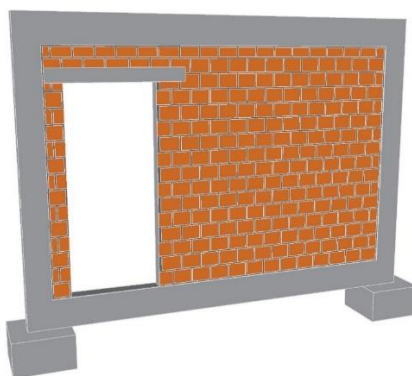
Modelo da parede maior em concreto armado e alvenaria com porta.
